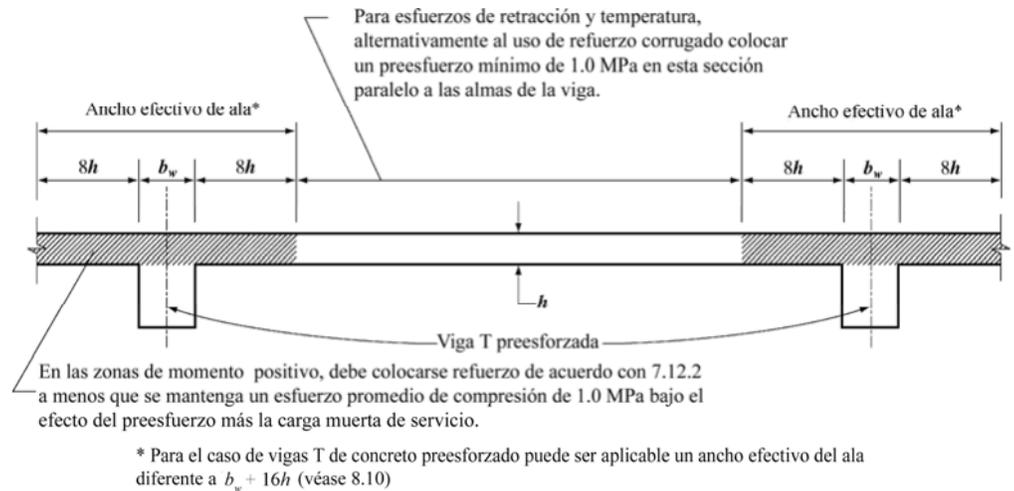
Preesforzado empleado para retracción y temperatura
